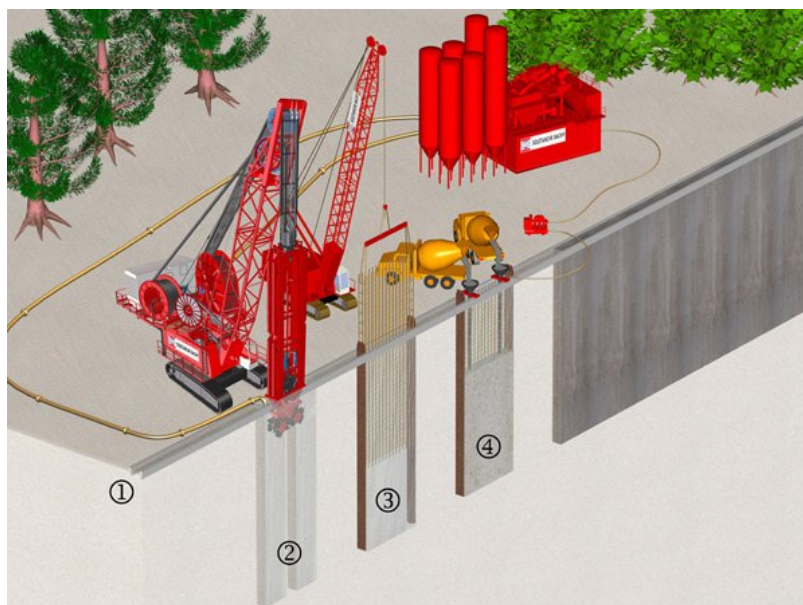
Возведение «стены в грунте»: 1 — устройство форшахты; 2 — разработка грунта в траншее; 3 — армирование стен; 4 — бетонирование стен [9]
